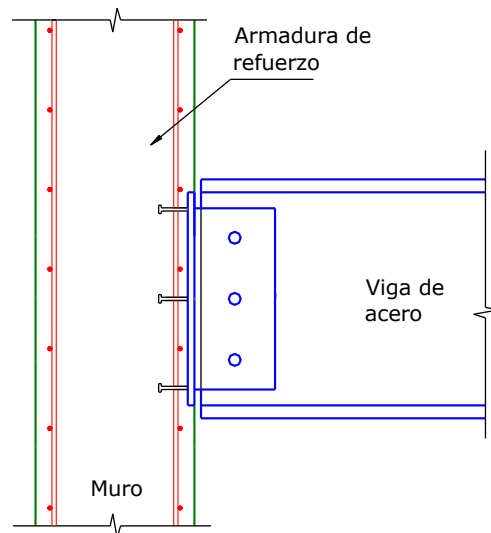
Conexión de una viga de acero con un muro de hormigón armado.
